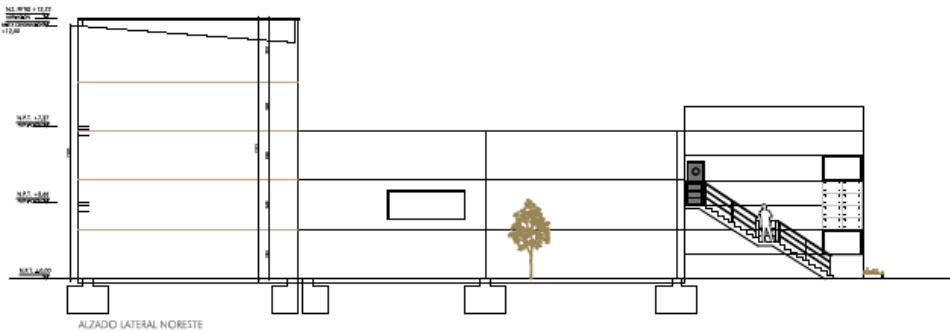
Alzado lateral noreste. Fuente: Arhotek
